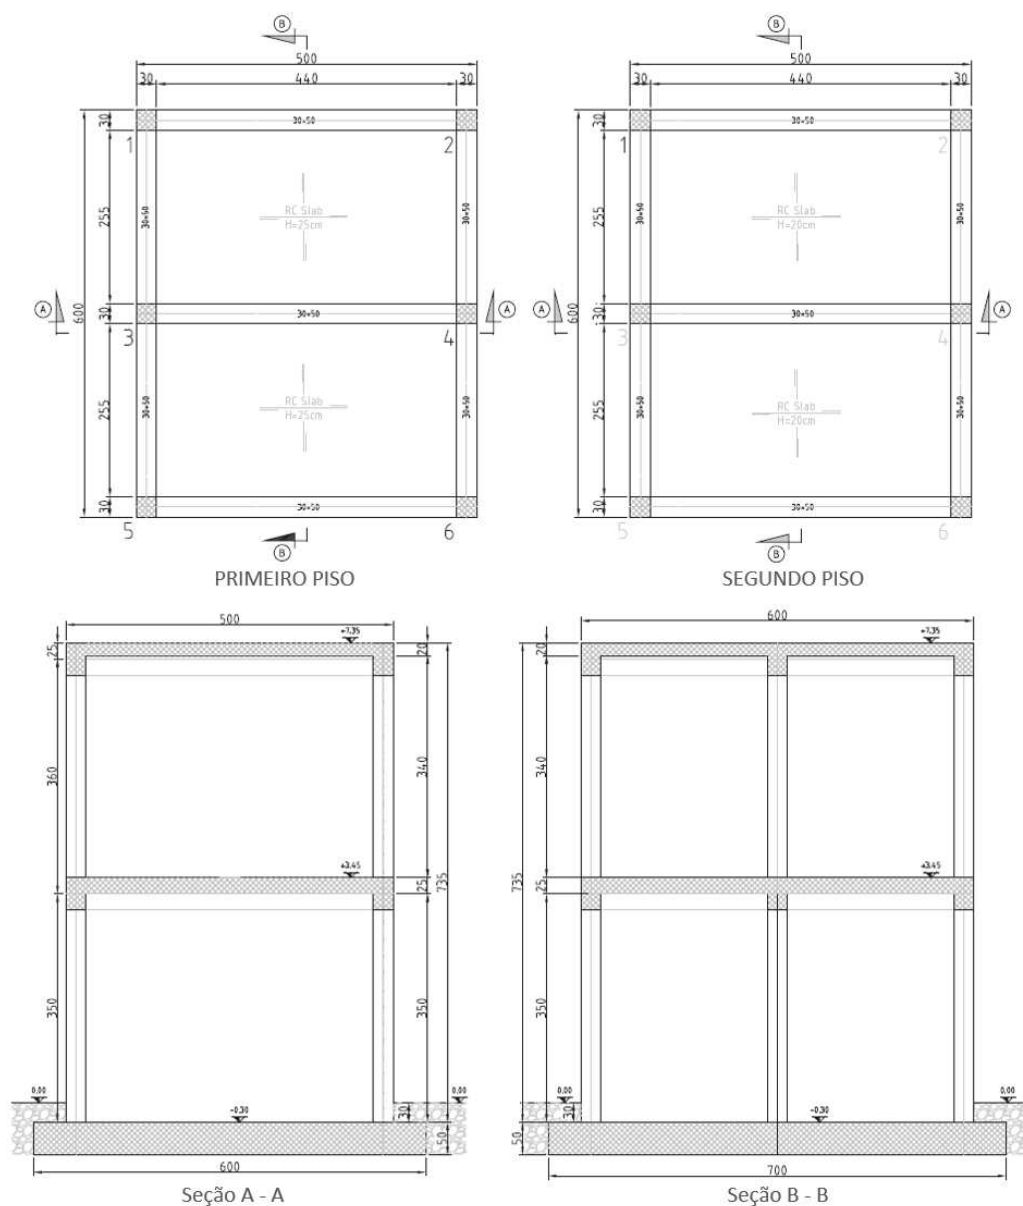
Plantas e cortes transversais das estruturas de teste [10]
